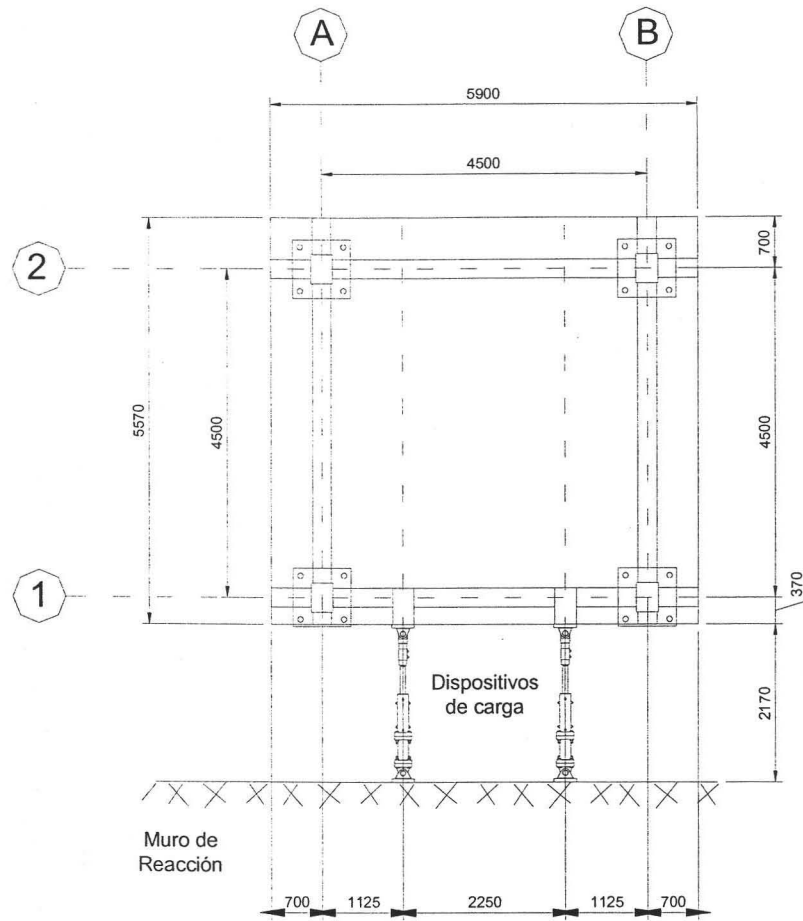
Vista en planta del modelo CR (acotaciones en mm)
